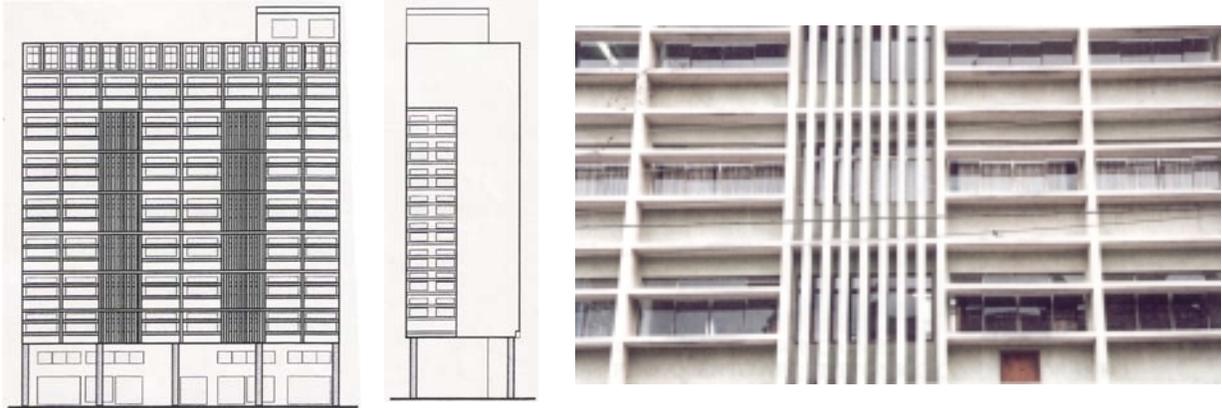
Cine Hotel Consórcio.Edifício Ibjé. Desenho Fachadas e foto de detalhe.
